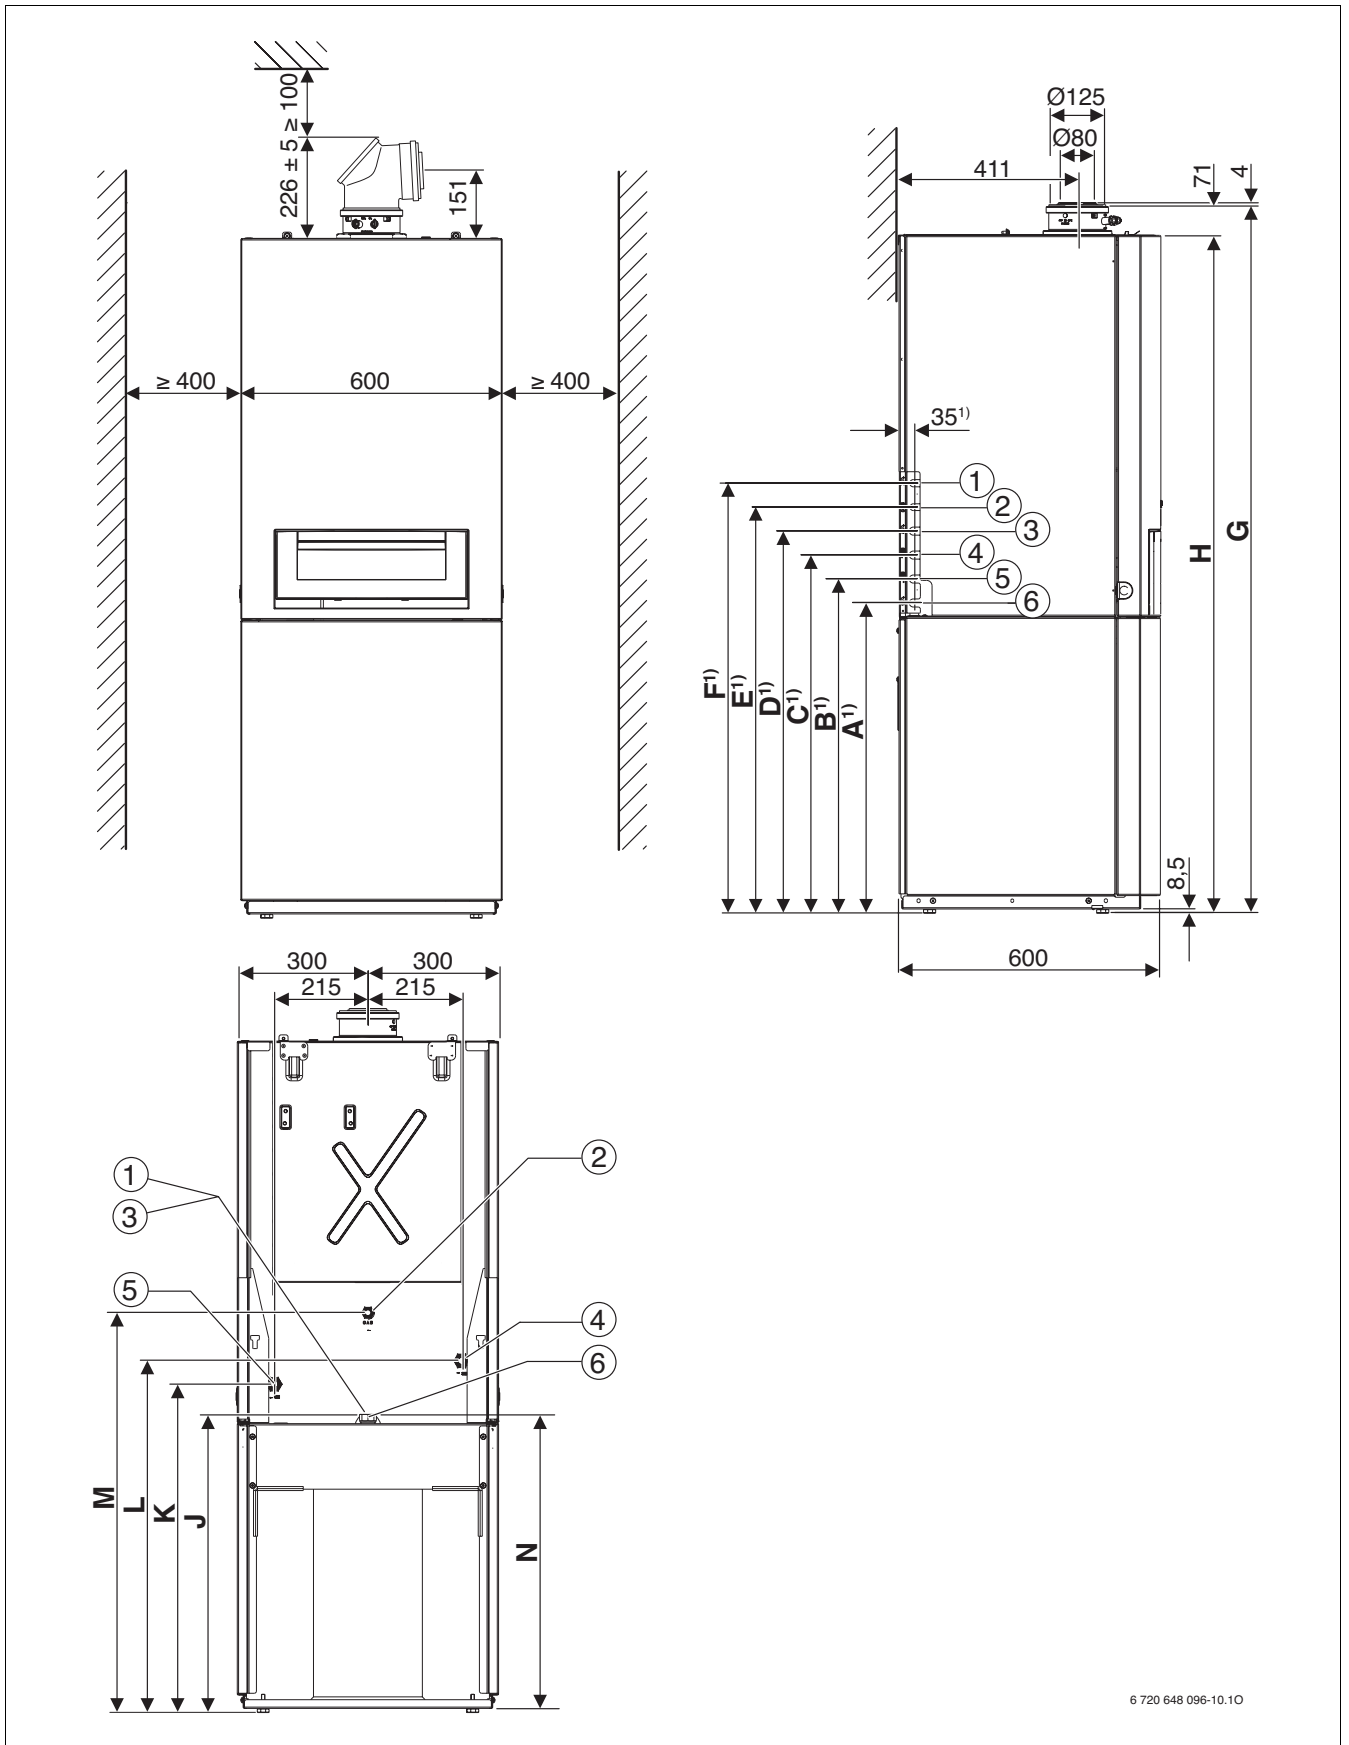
Abmessungen und Anschlüsse für GB172-14 T120, GB172-14/20 T150, GB172-20 T100S, GB172-14/24 T150S, (Maße in mm)
